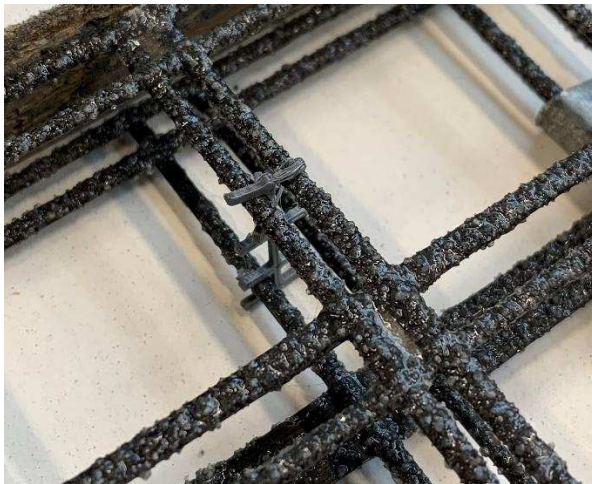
Zabetonované kotevní prvky ve Variantě B
